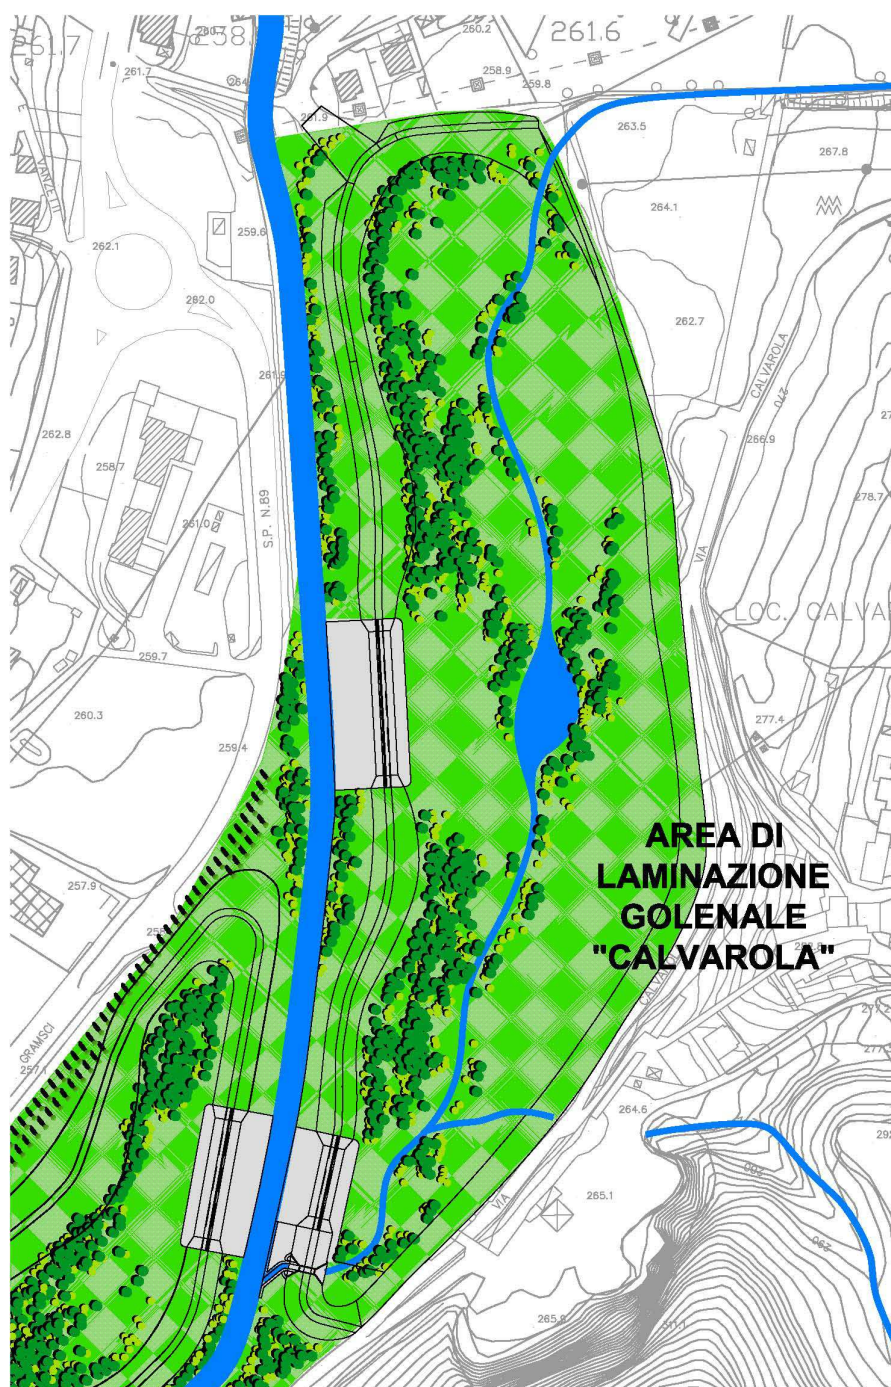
Planimetria dell'area di laminazione golenale "Calvarola" con progetto del verde
